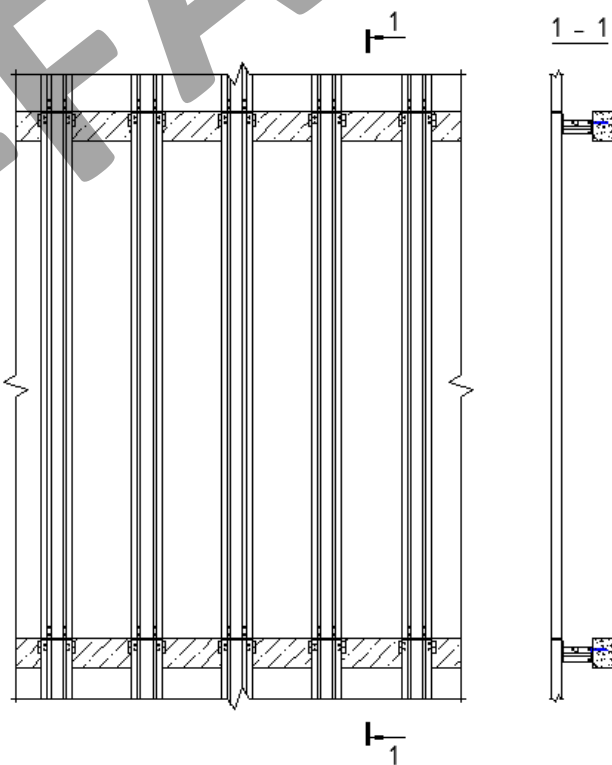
Система крепления в межэтажные перекрытия на основе кронштейна КНс-27
